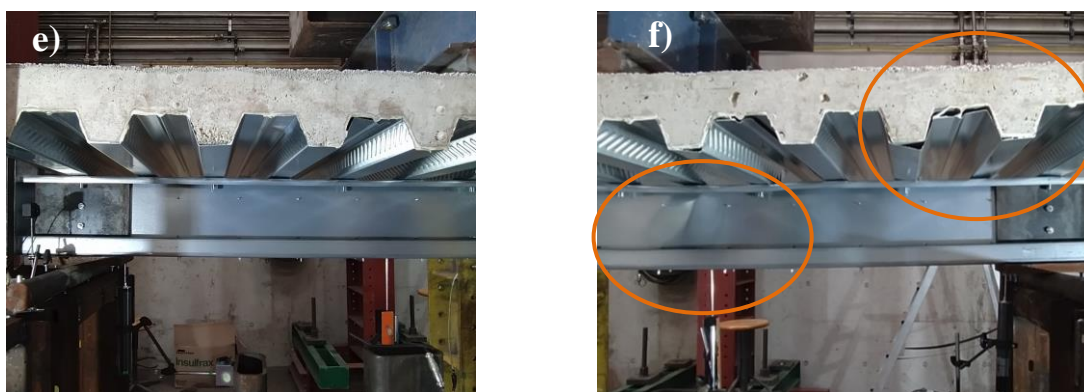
Comparação dos modos de rotura em ambas as extremidades. e) Reduzidos danos. f) Danos a nível de fissuras no betão, separação do betão da chapa, esmagamento da alma e corte longitudinal.
